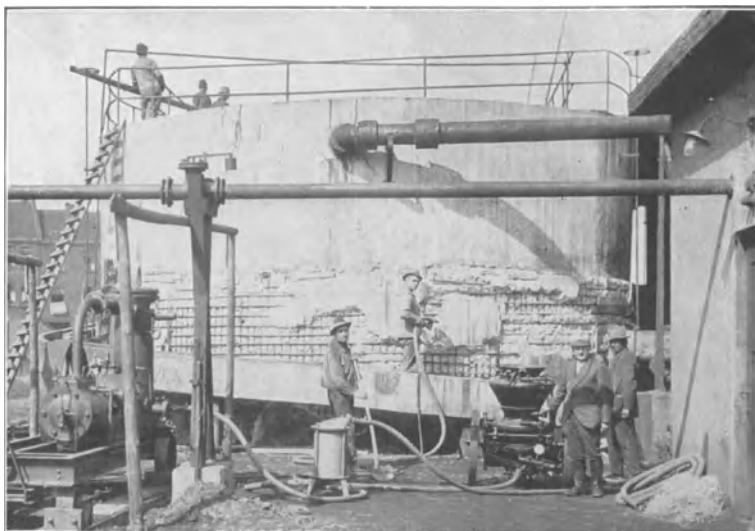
Wiederherstellung einer beschädigten Tunneldecke mit dem Torkretspritzverfahren.
